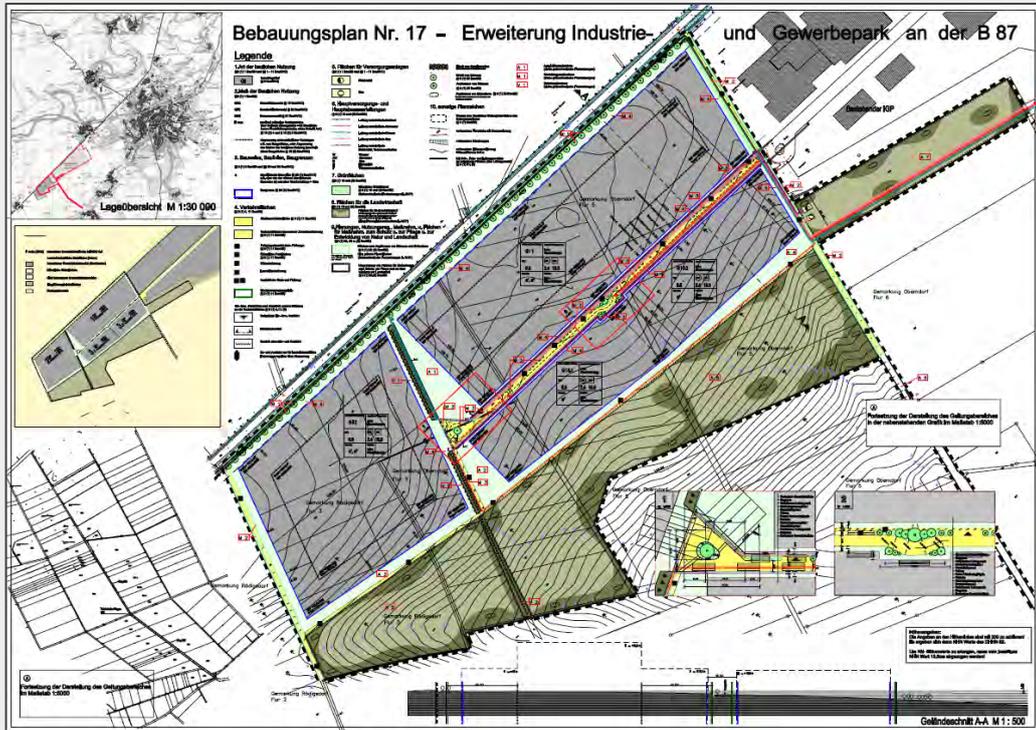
B-Plan „II. Erweiterung Industrie- und Gewerbepark an der B 87“, 2007
